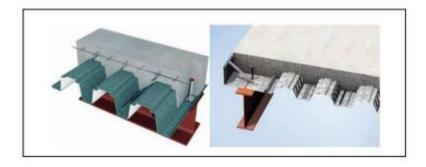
les composants d'une dalle mixte (Plancher Collaborant)
